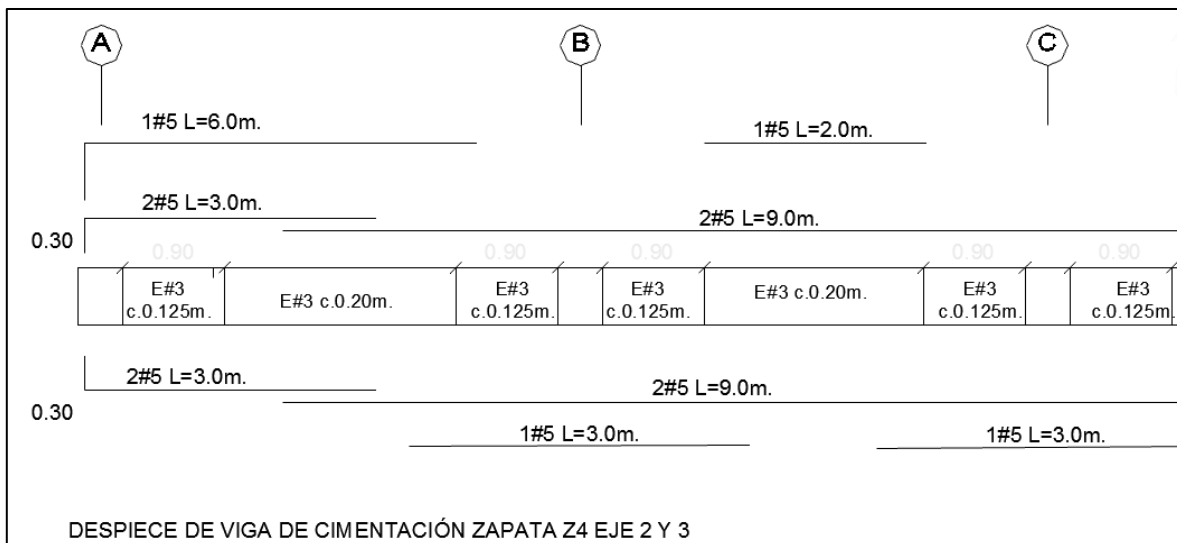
Figura XI Despiece de viga de cimentación de zapata Z4 eje 2 y 3.
